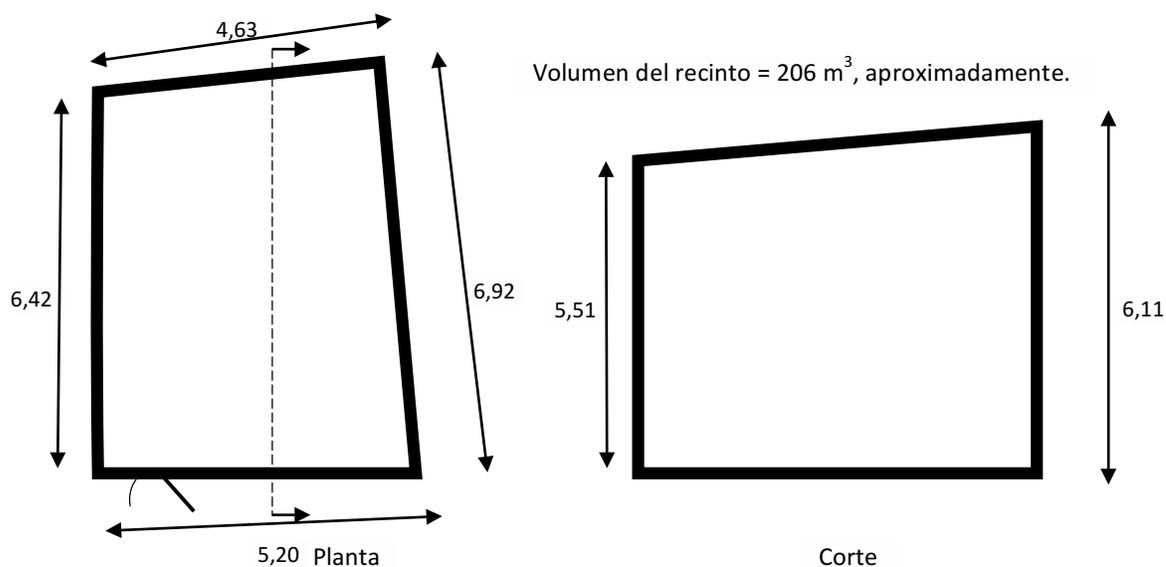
Esquema de planta y corte de los recintos de ensayo
